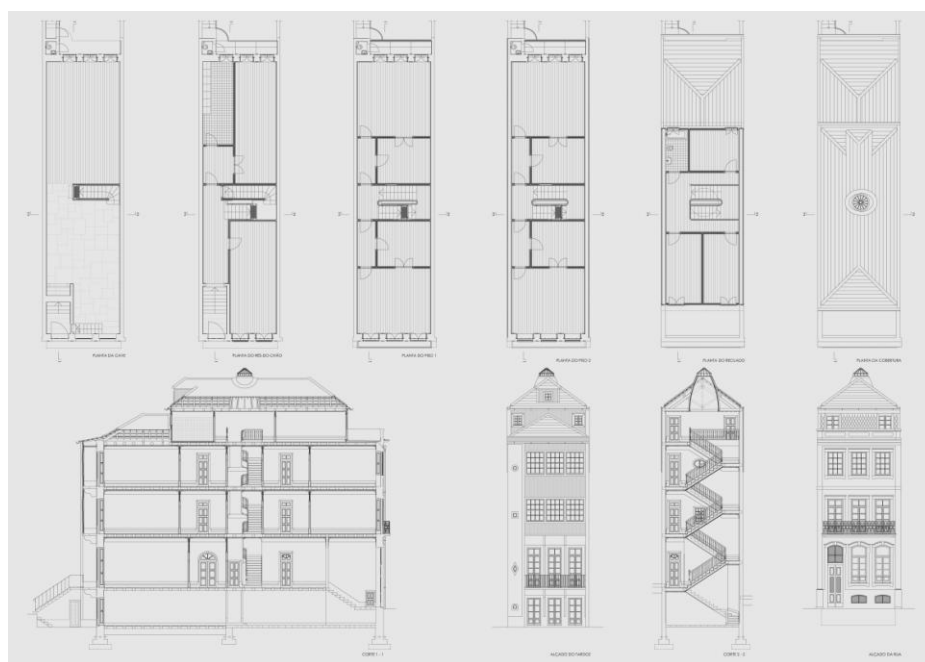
Plantas, cortes e alçados do modelo construtivo.
